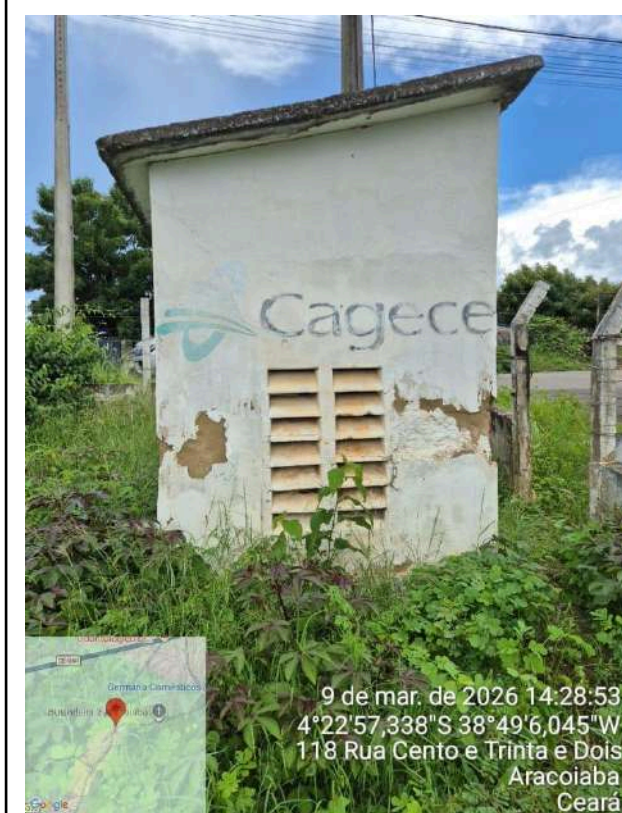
EERD-01: identificação desgastada, edificação apresenta degradação do revestimento em todas as suas laterais.
